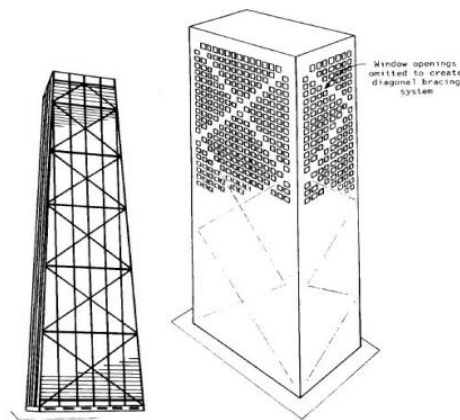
Sistema tubular arriostrado. Acero (izq.) Hormigón (der.)
